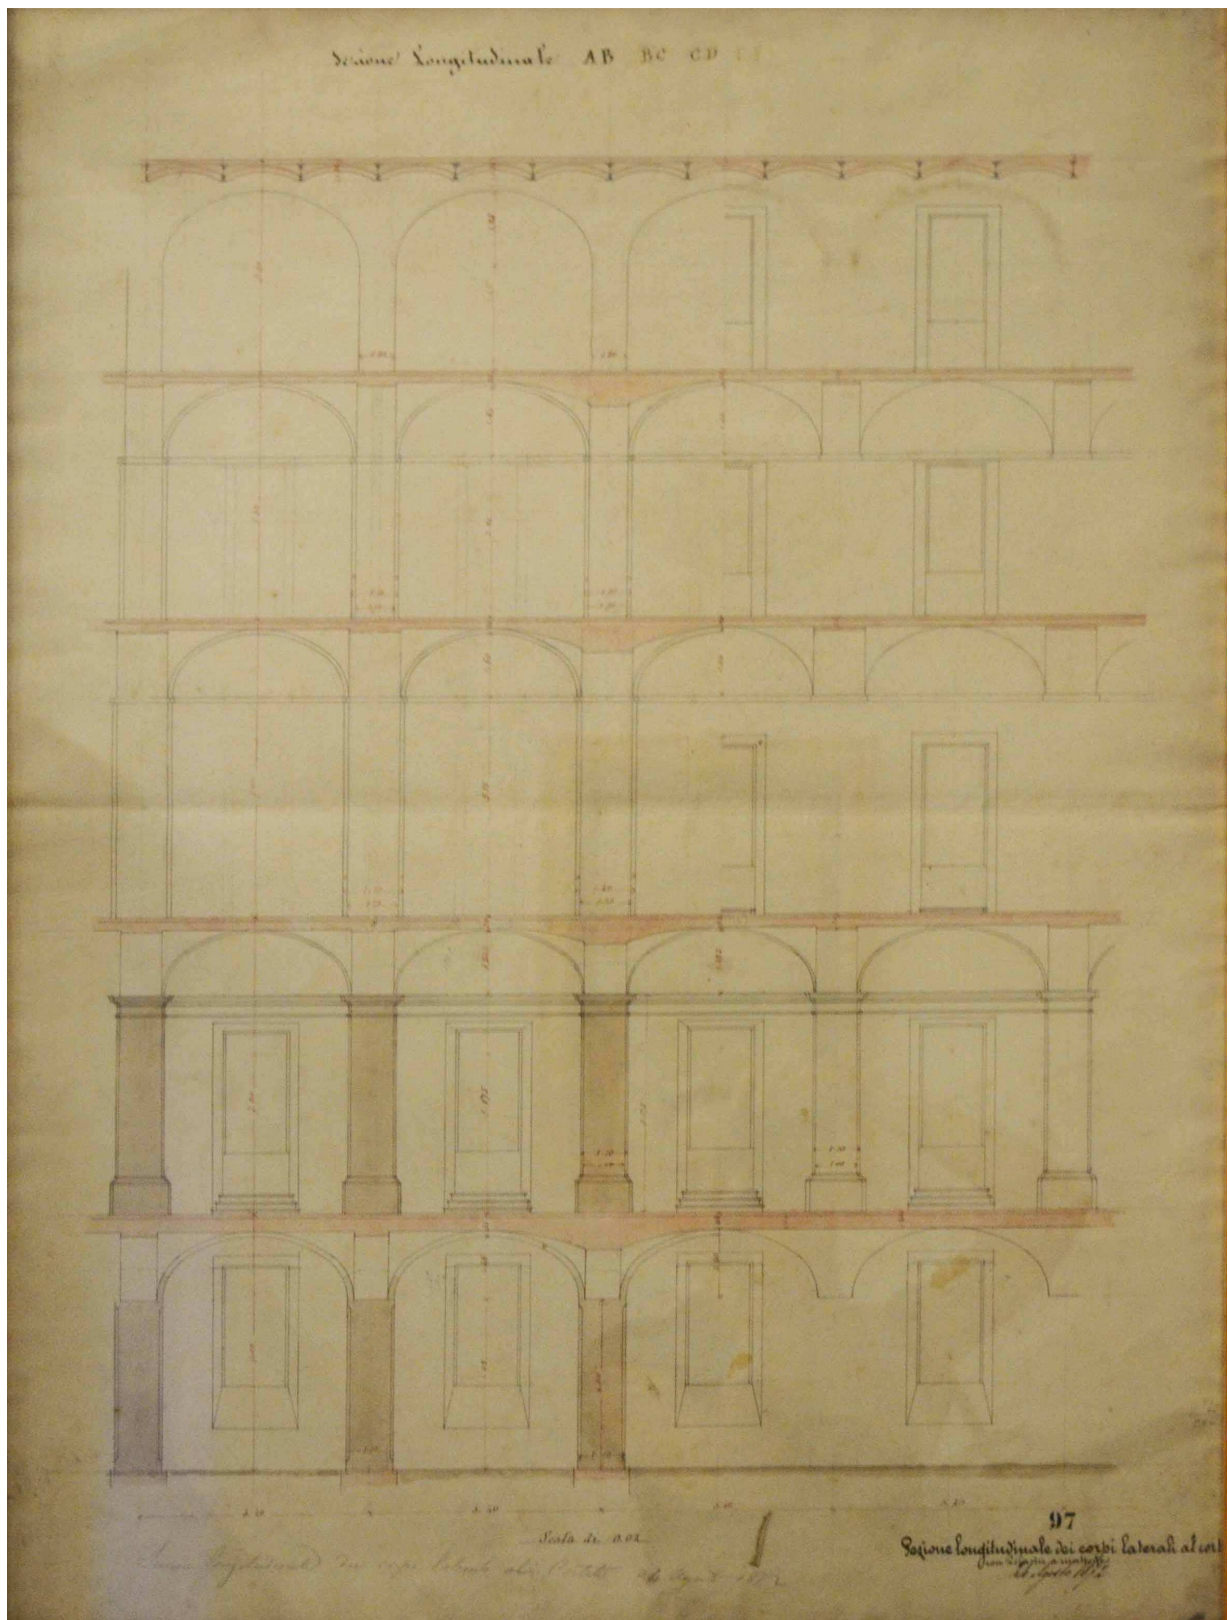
Sezione longitudinale dei corpi laterali al cortile centrale (15 agosto 1872) . Sostituzione del sistema portante in ghisa e acciaio con muratura continua tradizionale (Sala n.8, Piano delle Sostruzioni, BSMEF)
